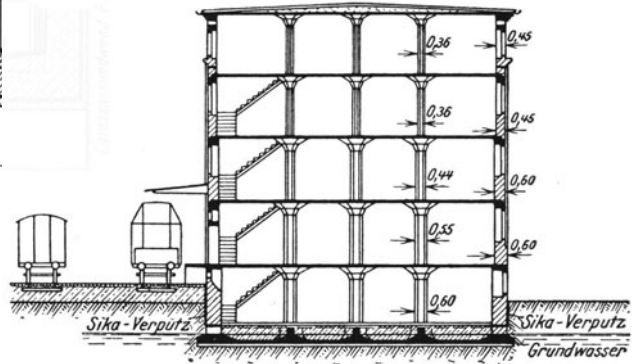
Mehllager einer Dampfmühle. (Nach W. Obrist: Beton u. Eisen 1929 S. 443.)
